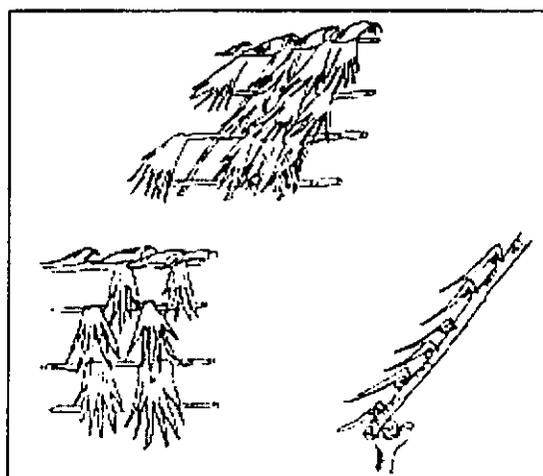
Estructura de anclaje de las hojas de palma. (Ídem)
